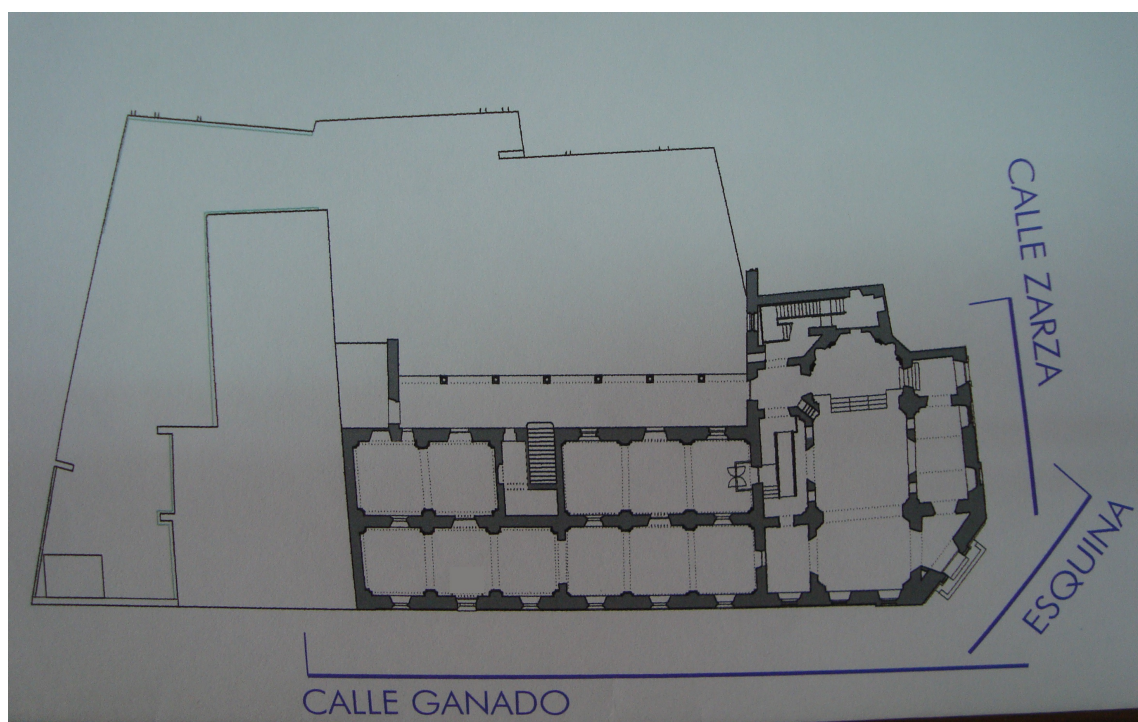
Planta baja de Hospitalito sin la entrada en calle Ganado, (NAVARRO, 2009)
